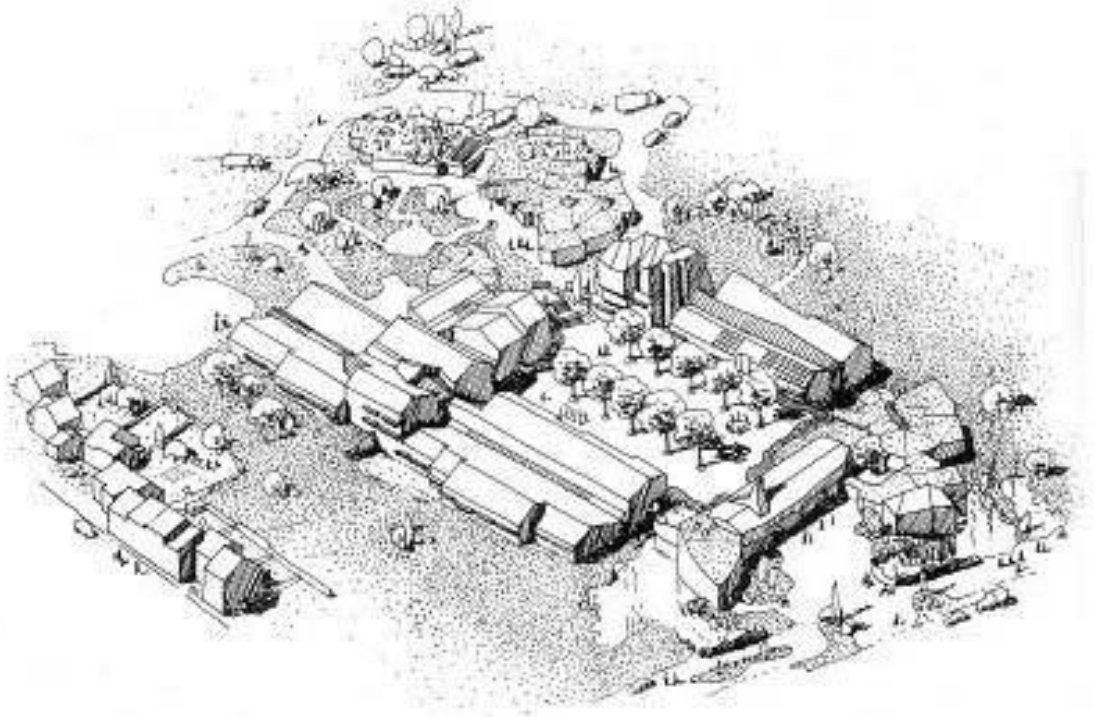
Vaziyet planı (<http://www.imagineschooldesign.org/detail.html>, 2011)
